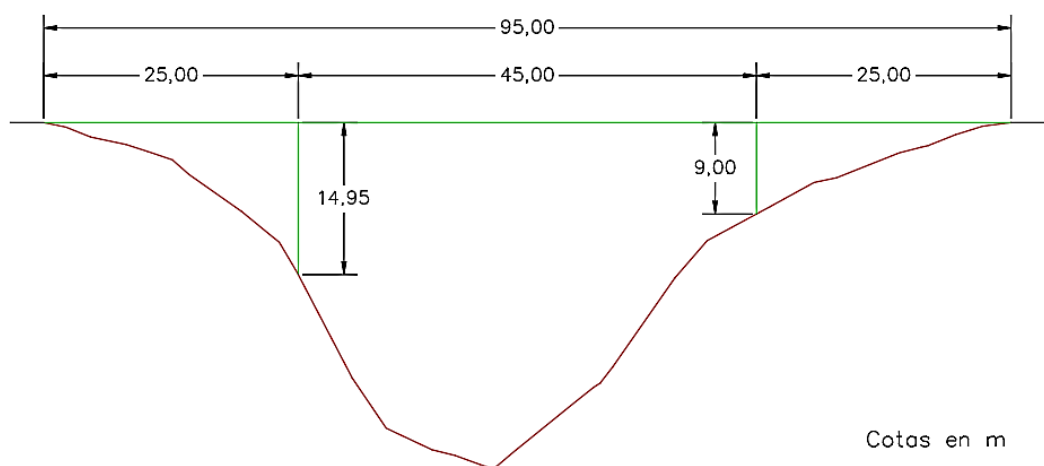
Esquema acotado de la estructura en sección longitudinal
